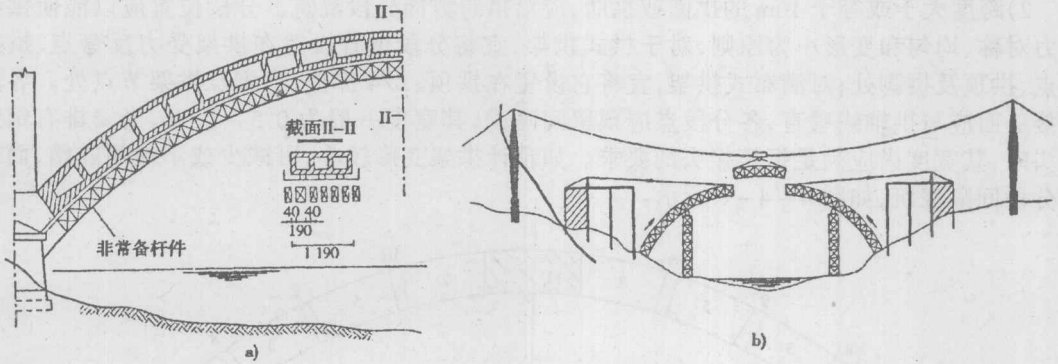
钢拱架构造型式(尺寸单位:cm)
